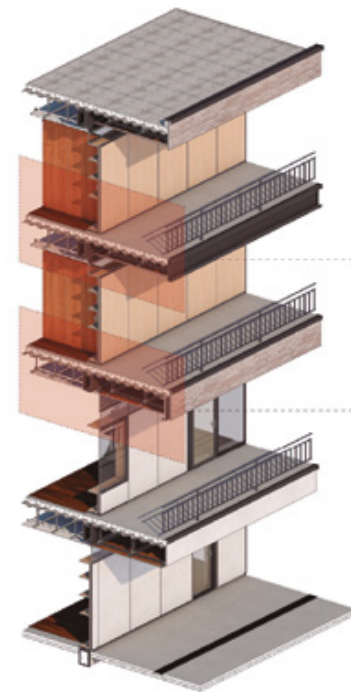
Sección constructiva 1er septenio | Fuente: Elaboración propia
